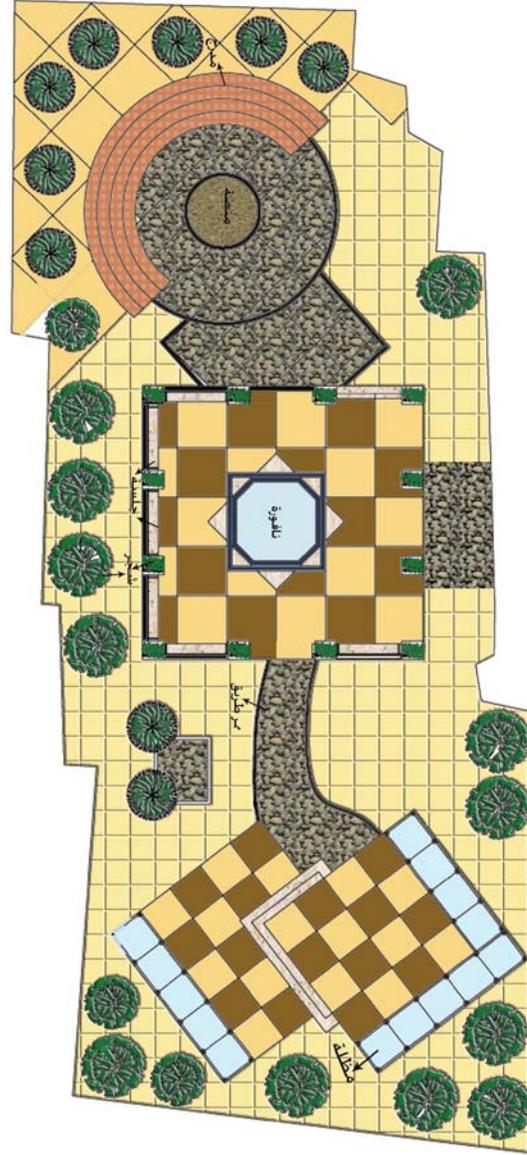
مخطط الفرش المقترح للطابق الأرضي
